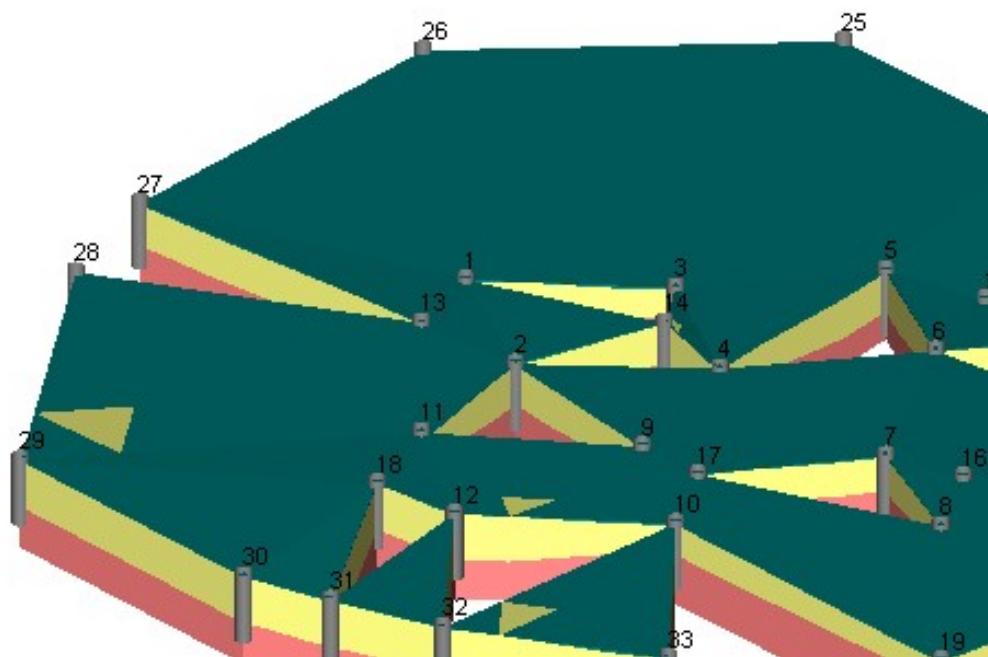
Срез основание фундаментной плиты на отметке +41.16
